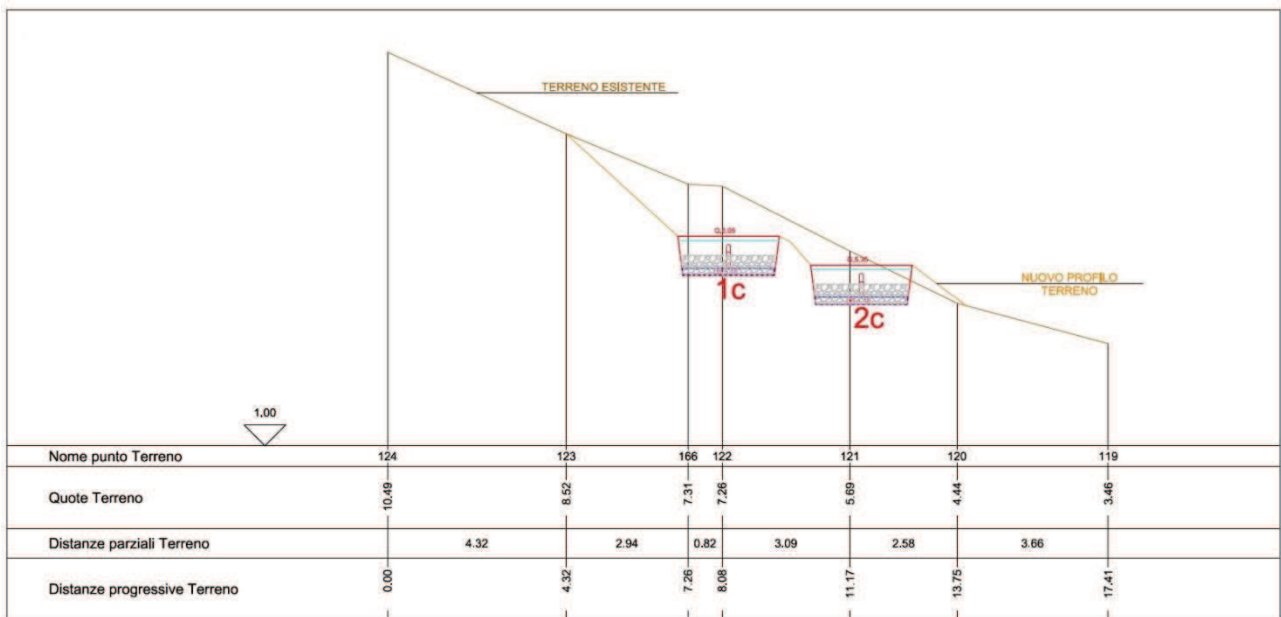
Sezione B-B' 1:100; (fonte: Parco dell'Adamello)
